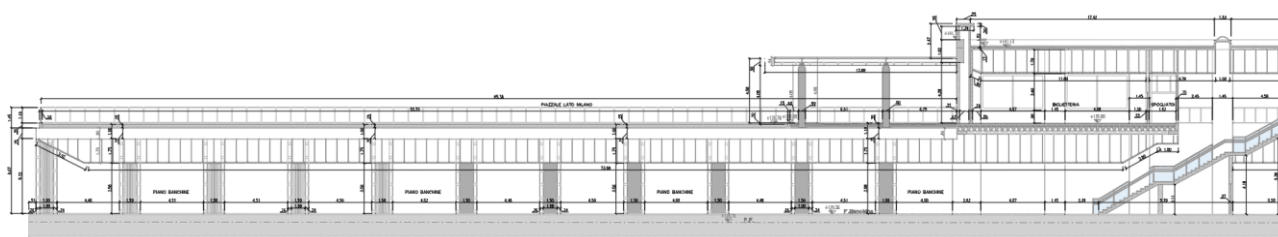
Sezione longitudinale nuovo Piazzale lato Milano
